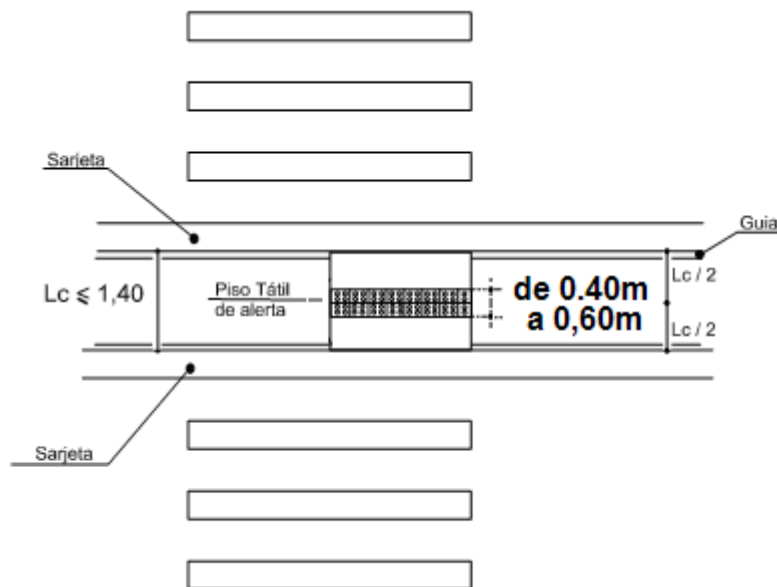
Planta - Rebaixamento em canteiro central inferior a 1,40m.
